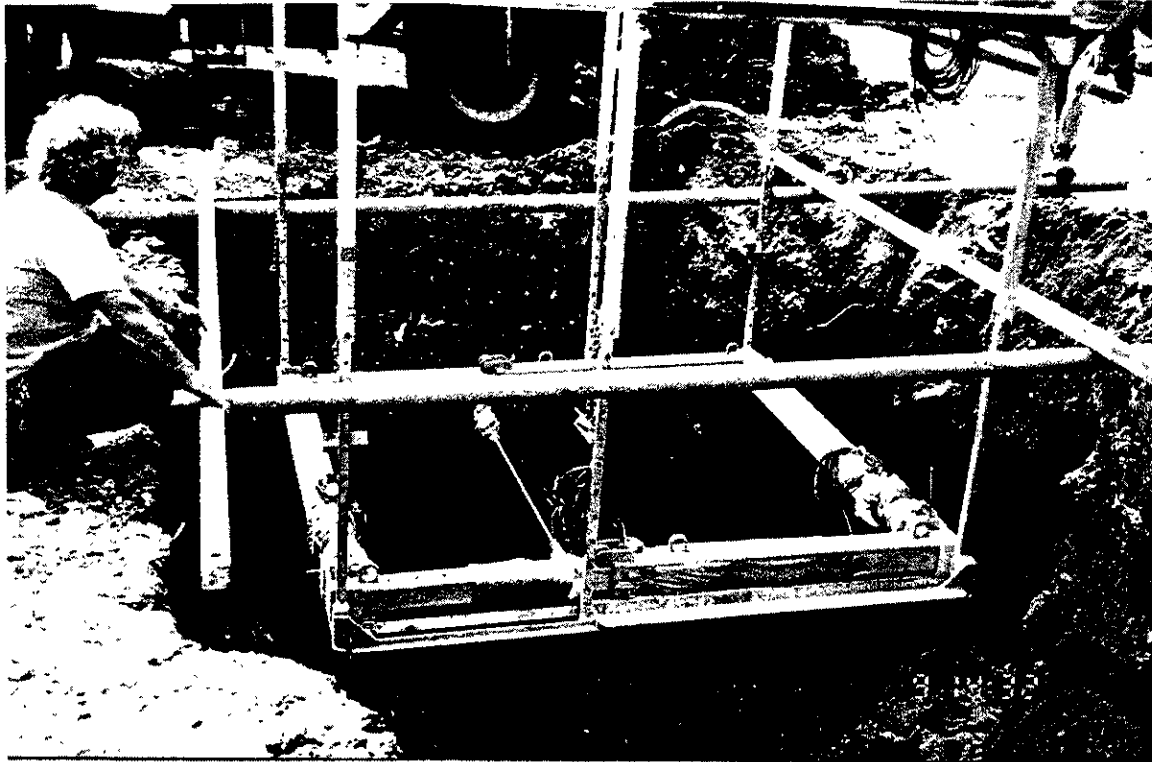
Excavation du puits d'essai (Carrière Francon)
